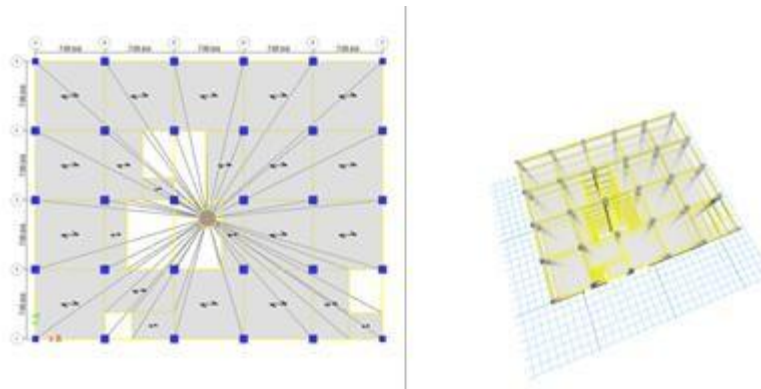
Modelamiento del edificio de 8 pisos, vista de planta y elevación, diafragma rígido
